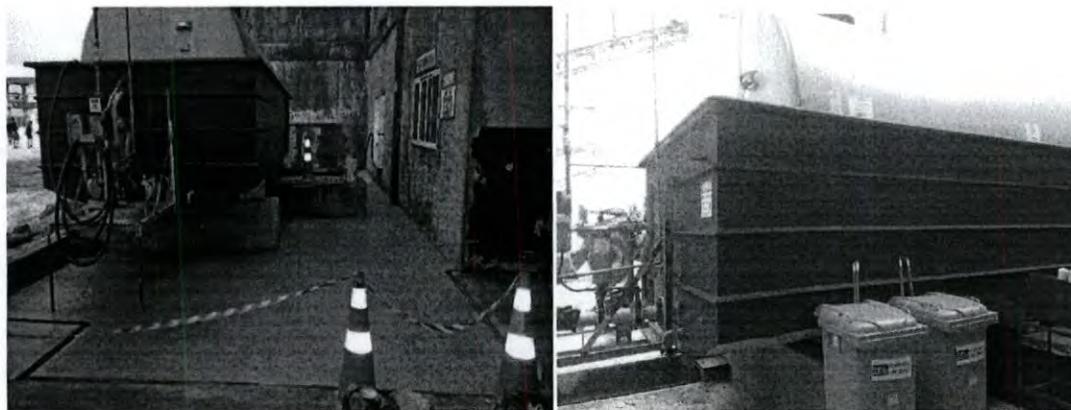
Instalação do Sistema de Contenção para abastecimento no Terminal (A e B)
